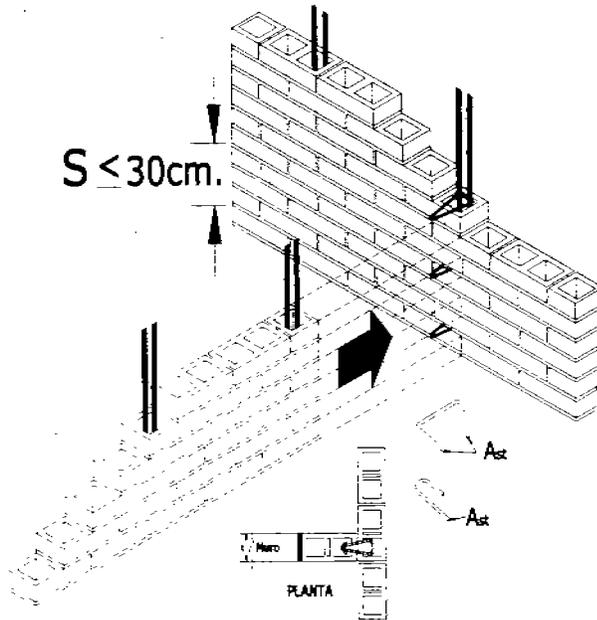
CONECTORES ENTRE MUROS SIN TRASLAPE DE PIEZAS
